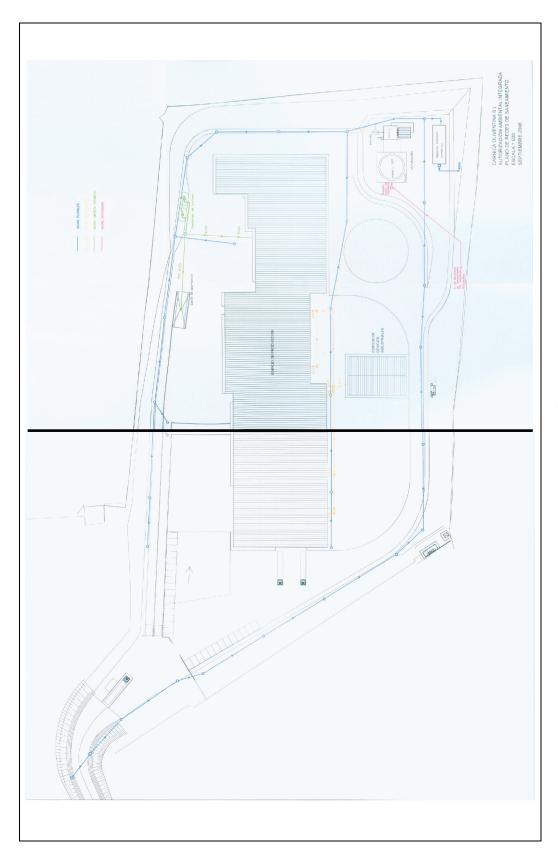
Plano en planta de la instalación con las redes de saneamiento
